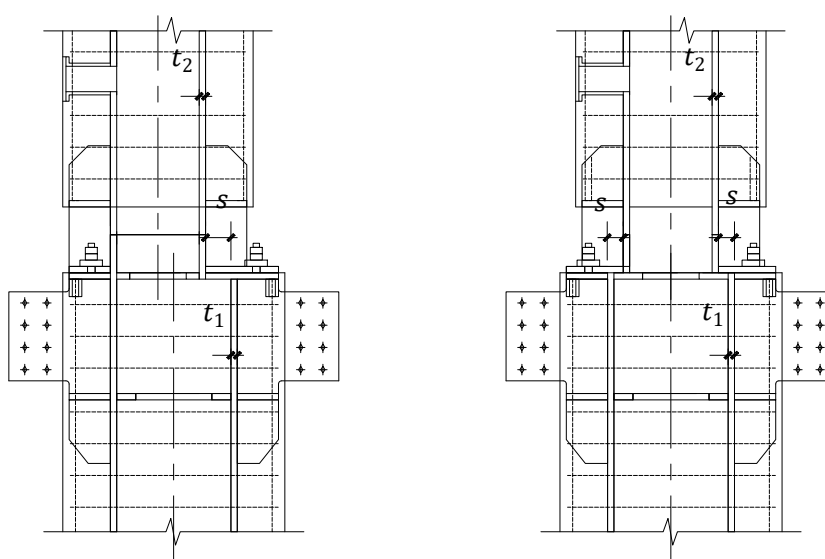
a 矩形截面预制型钢混凝土柱变截面拼接节点的构造
